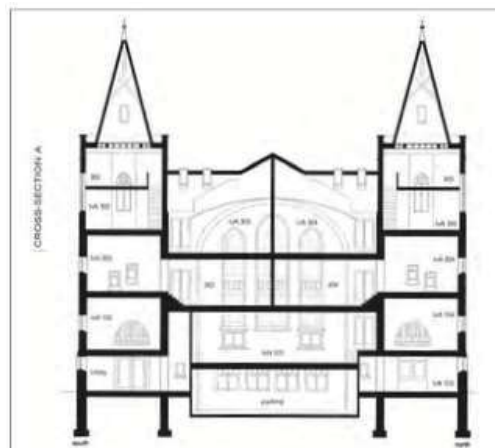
“The Church Lofts” Sección transversal, Norte-Sur mirando al Oeste / Arq. Bernard Watt, 2009
